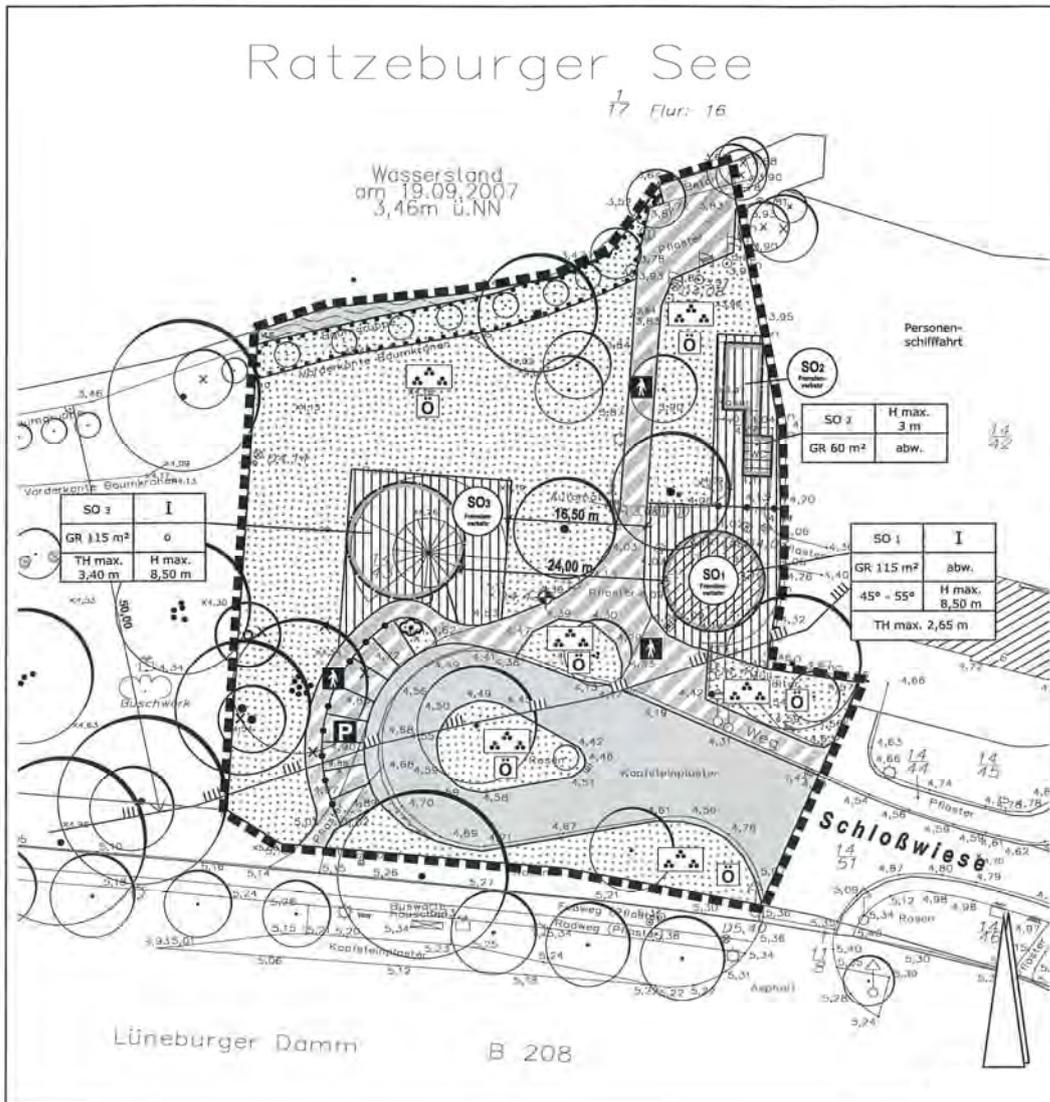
Planzeichnung des rechtskräftigen B-Plans Nr. 77 (ohne Maßstab)
